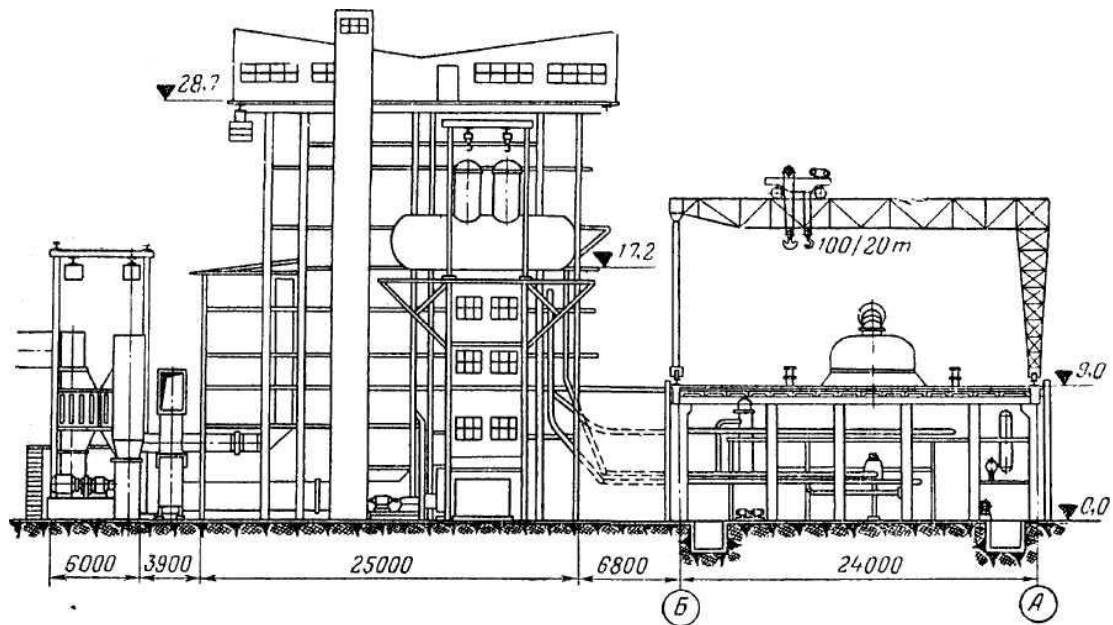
Поперечный разрез по главному корпусу ТЭС открытого типа
